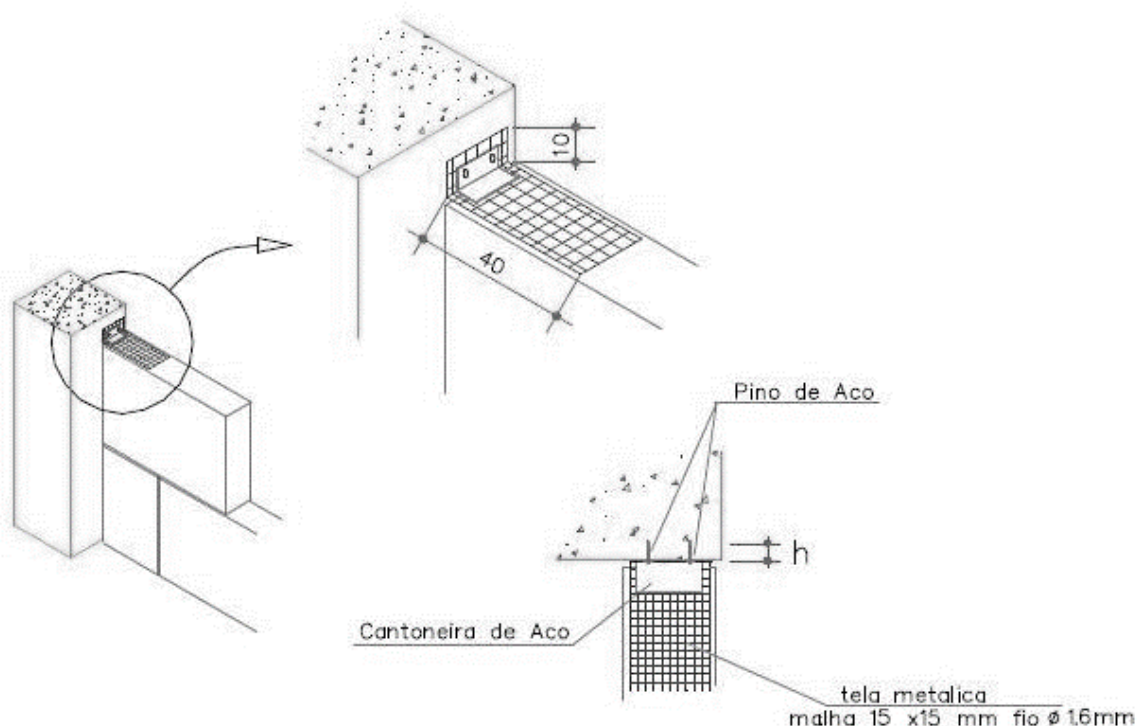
Utilização de telas eletro soldadas para ligações entre alvenarias e pilares de concreto. Fonte: Adaptado de Medeiros (1999).
